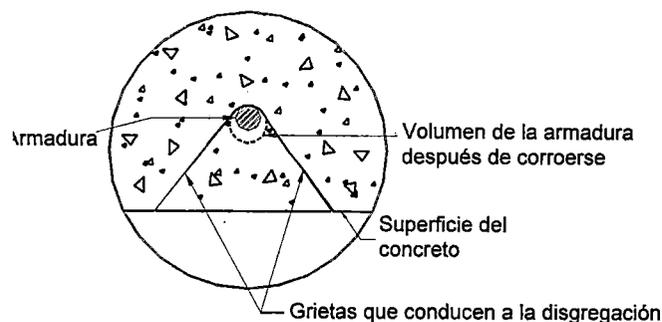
Grietas en el concreto debidas a la corrosión de las armaduras
